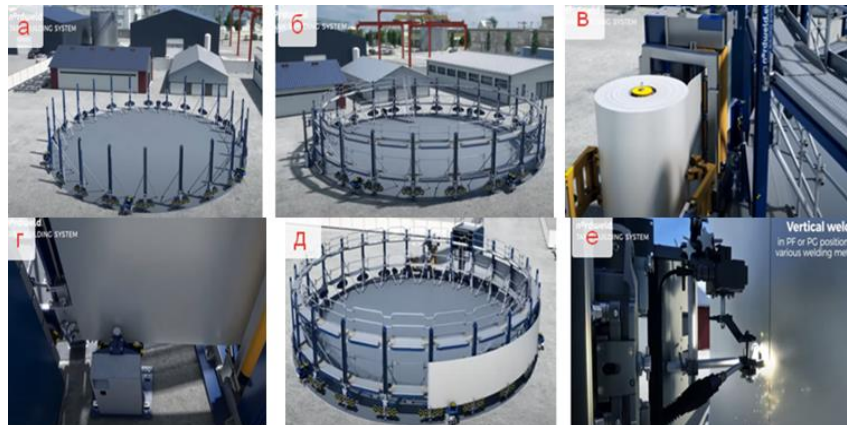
Основные технологические процессы (монтаж домкратов — подъем верхнего (первого) пояса) сборки вертикальных стен из рулонной стали высотой на один пояс с помощью подъемной системы Lift Jack: а — монтаж подъемной системы; б — устройство подмостей на вертикальных опорах подъемной системы; в — завальцевание рулонной цельнолистовой стали; г — перекатка завальцованной рулонной стали верхнего (первого) пояса по периметру РВС; д — сборка верхнего (первого) пояса РВС из рулонной цельнолистовой стали; е — сварка вертикального стыка верхнего (первого) пояса РВС (<https://www.youtube.com/watch?v=Mp4AeMoFviA>)
